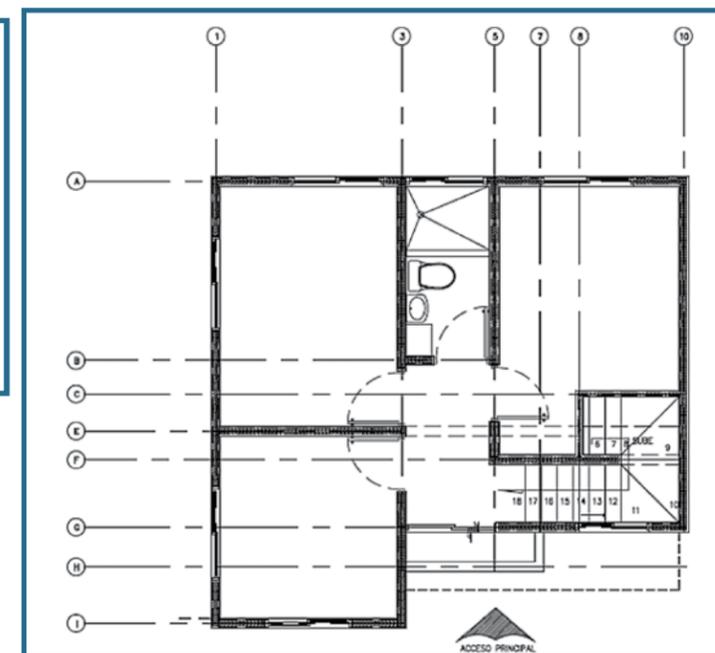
Planta arquitectónica vivienda 2do. nivel.
